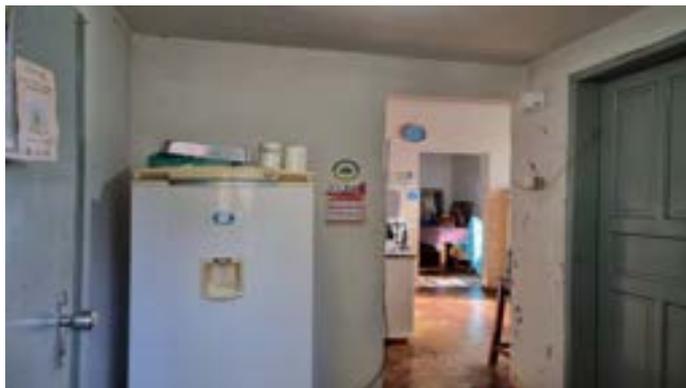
FOTO DA PEQUENA ÁREA DE CIRCULAÇÃO
